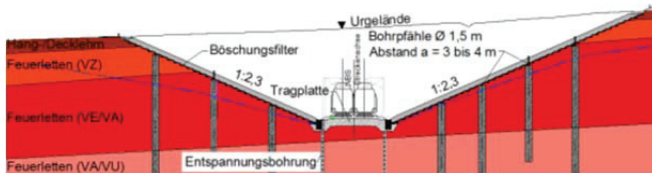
Voreinschnitt Nord Tunnel Lichtenholz
